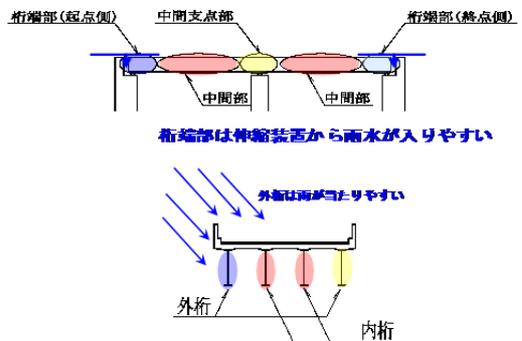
損傷発生箇所概略図(上:縦断面図、下:横断面図)
